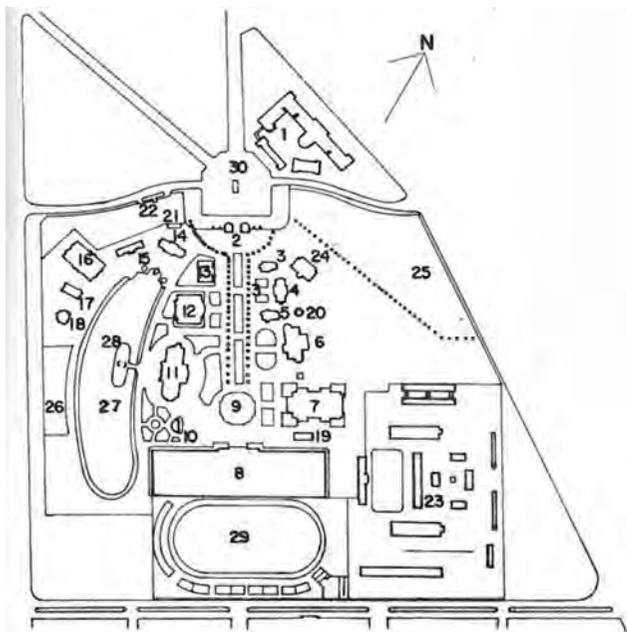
Planta da Exposição de 1935. 1. Pavilhão Cultural; 2. Entrada Monumental; 3. Pavilhão Santa Catarina; 4. Pavilhão Minas Gerais; 5. Pavilhão Paraná; 6. Pavilhão Agricultura; 7. Pavilhão Indústria Estrangeira; 8. Pavilhão Indústria Rio-Grandense; 9. Fonte luminosa; 10. Coreto; 11. Cassino; 12. Pavilhão São Paulo; 13. Pavilhão Pernambuco; 14. Pavilhão Distrito Federal; 15. Pavilhão Pará; 16. Pavilhão Viação Férrea; 17. Pavilhão IFE-EFCB; 18. Pavilhão do Café; 19. Café-Bar; 20. Sanitários; 21. Pavilhão da Administração; 22. Posto de serviços automóveis; 23. Pecuária; 24. Restaurante; 25. Parque de Diversões; 26. Jardim de Infância; 27. Lago; 28. Belvedere; 29. Canódromo; 30. Monumento.
